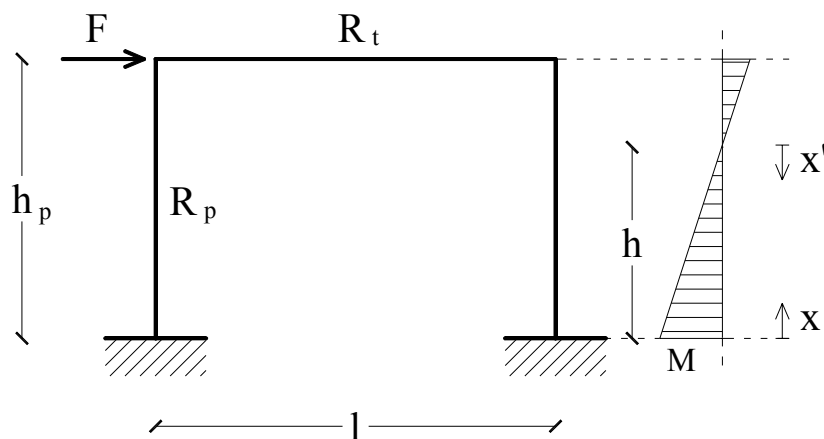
Schema statico a telaio con travi e pilastri deformabili.
